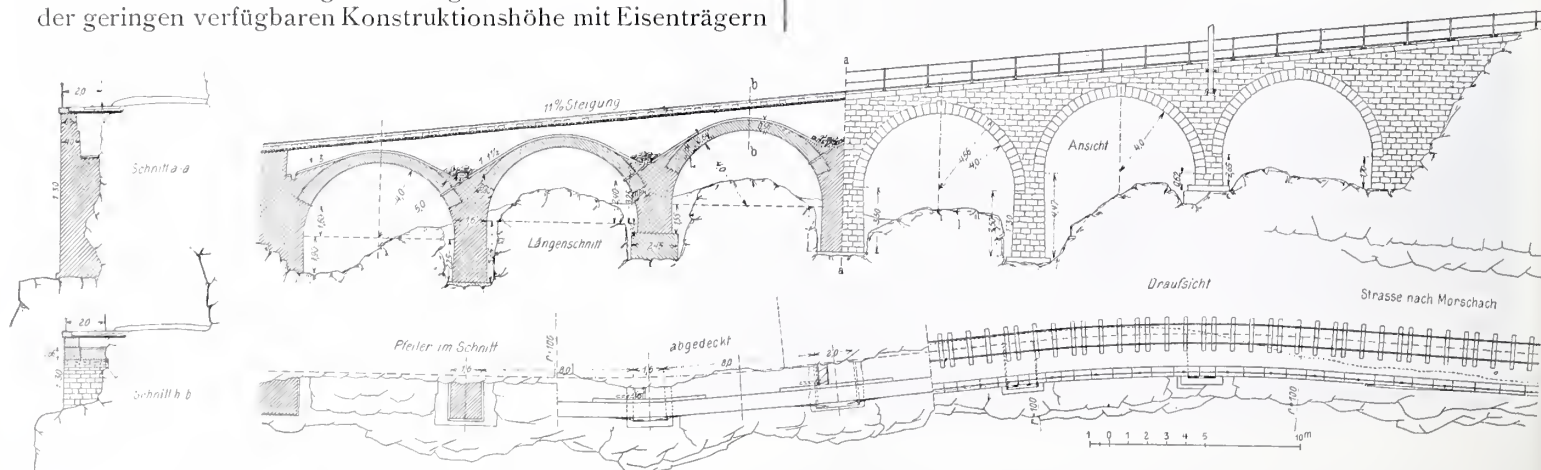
Lehnenviadukt bei Km. 1,1 bis 1,2. — Grundriss, Ansicht, Längenschnitt und Querschnitt. — Masstab 1 : 400.
